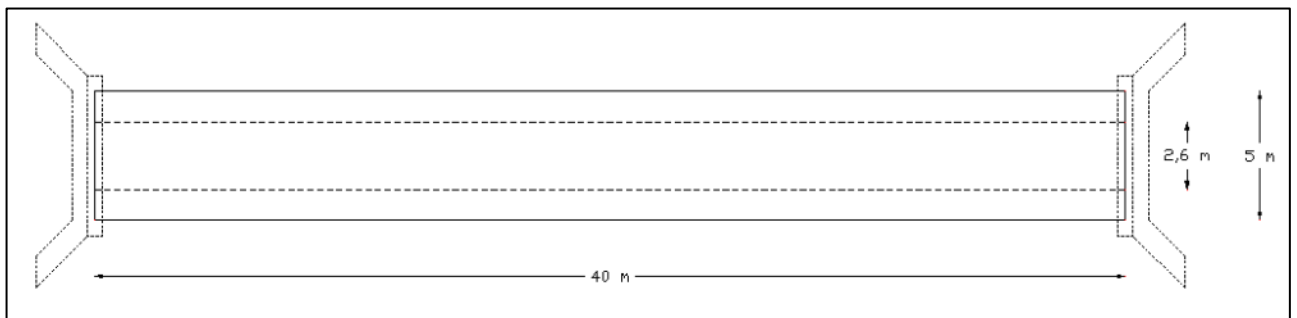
Sección Longitudinal de la Superestructura del puente sobre el Río Chicaña
